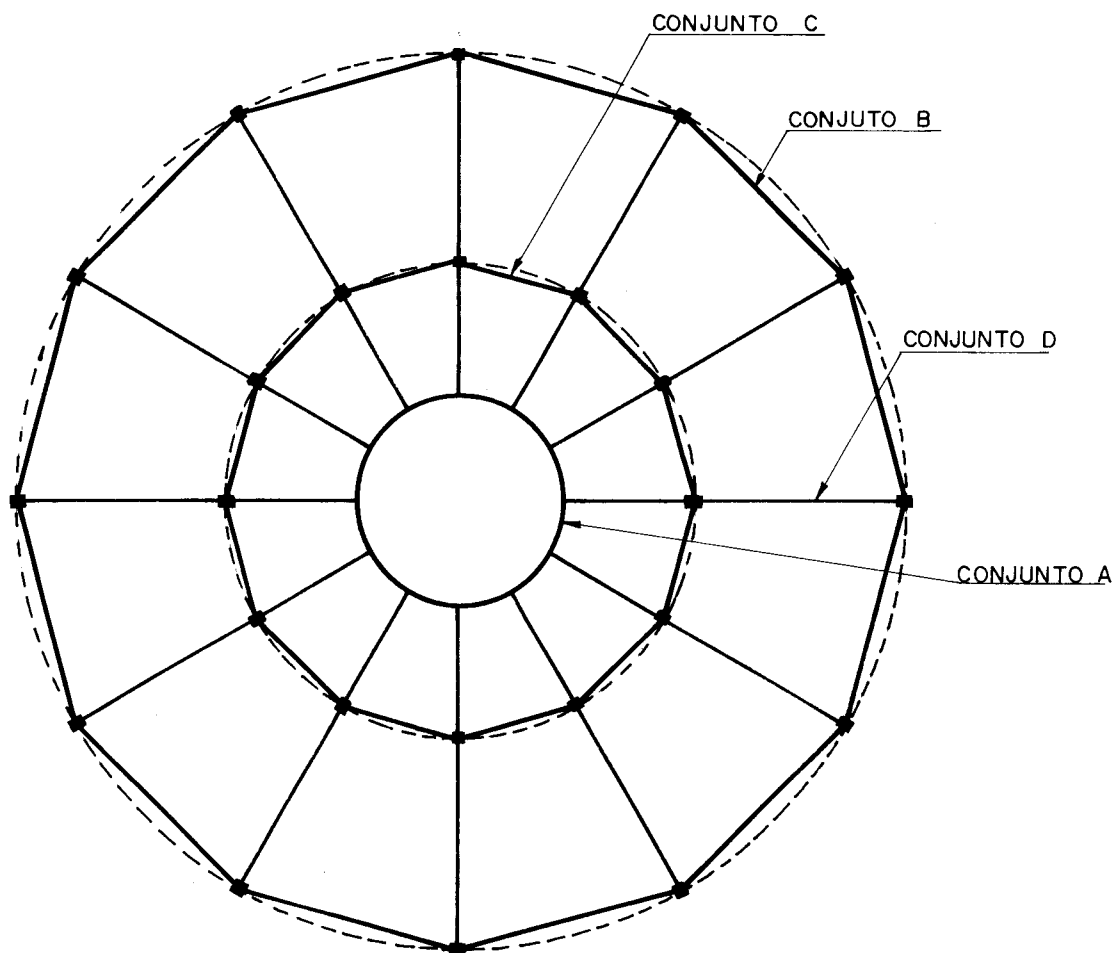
EDIFÍCIO DO TIPO MAIS GERAL, EM PLANTA
